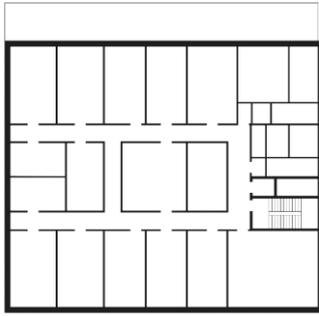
Vorentwurf Grundriss Regelgeschoss SGA
